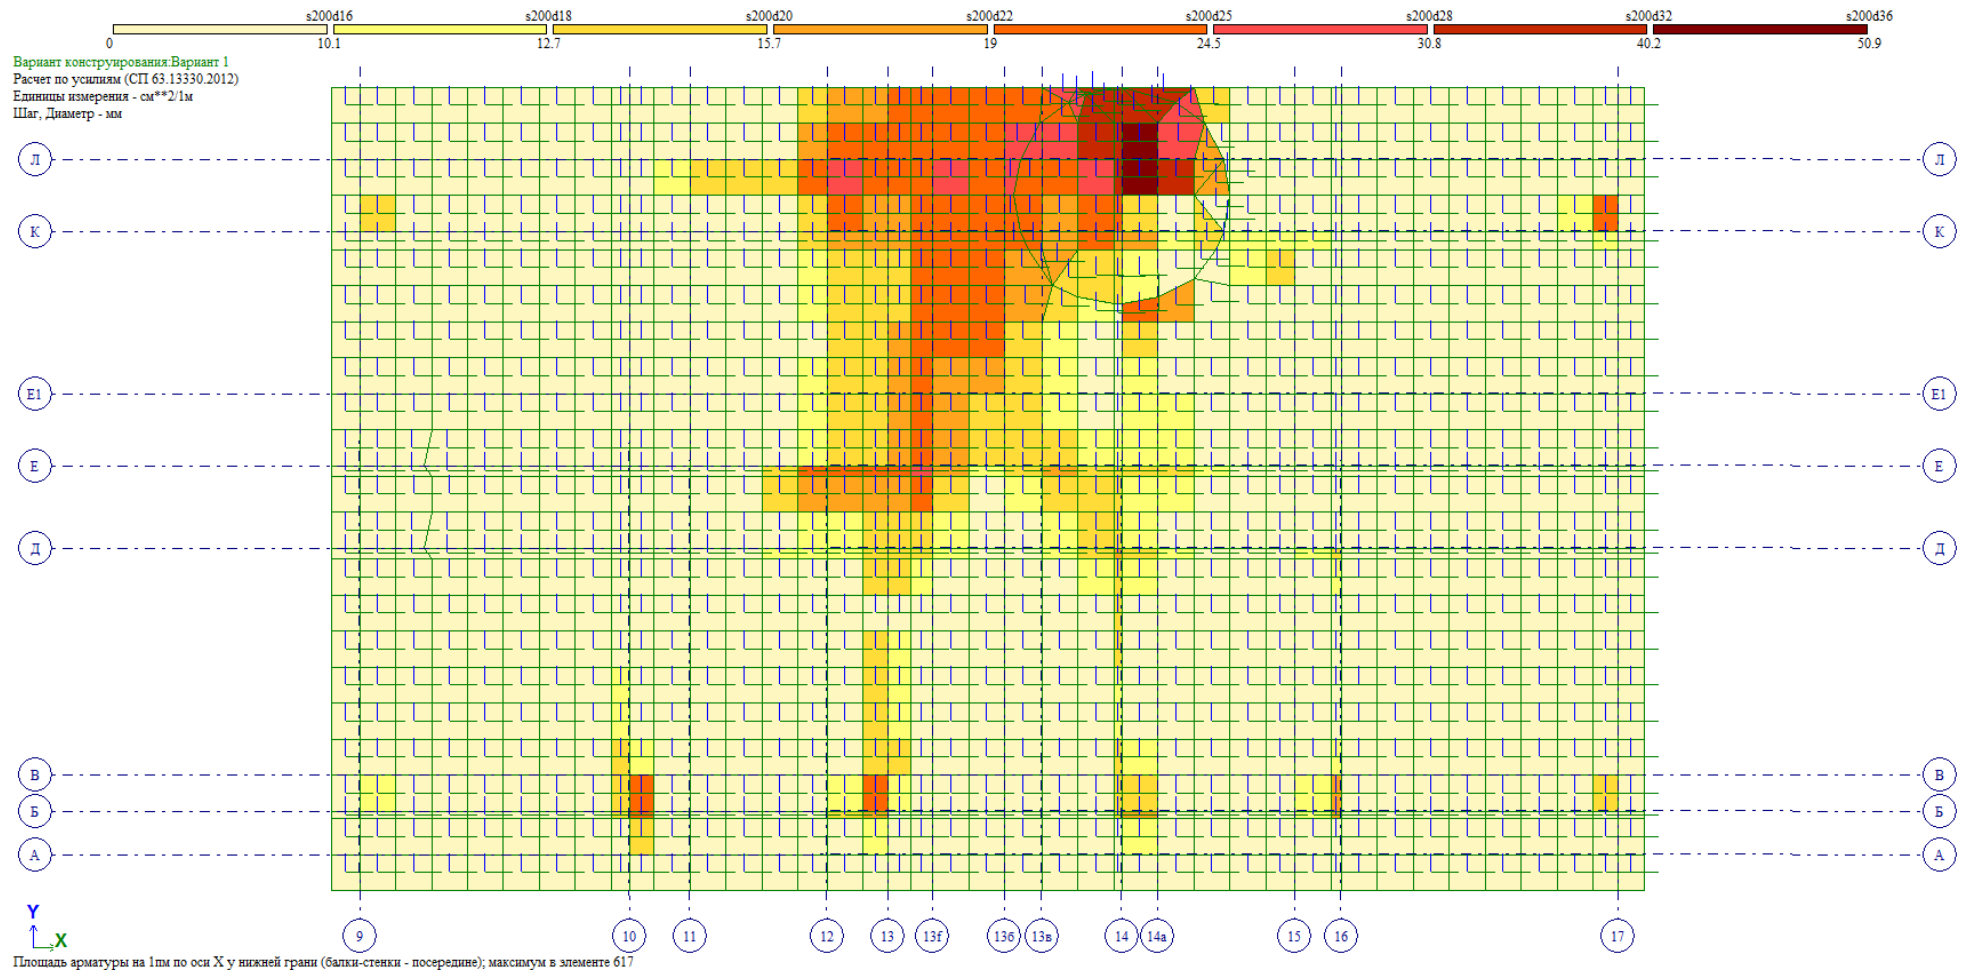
Площадь арматуры у нижней грани фундаментной плиты по оси X (карстовая воронка расположена в осях 14/Л секции В)
